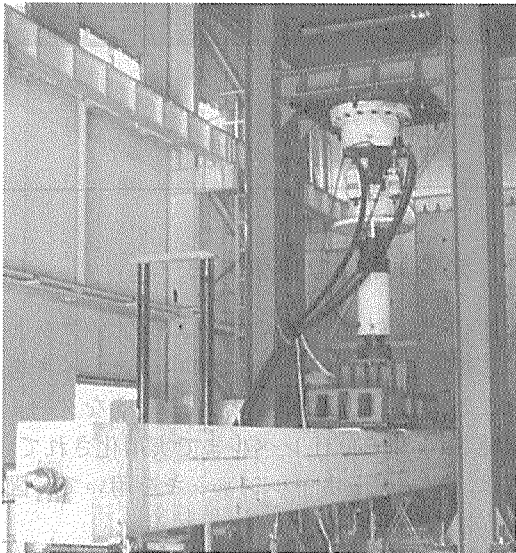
ポステン試験桁 (L=10 m) 疲労試験
